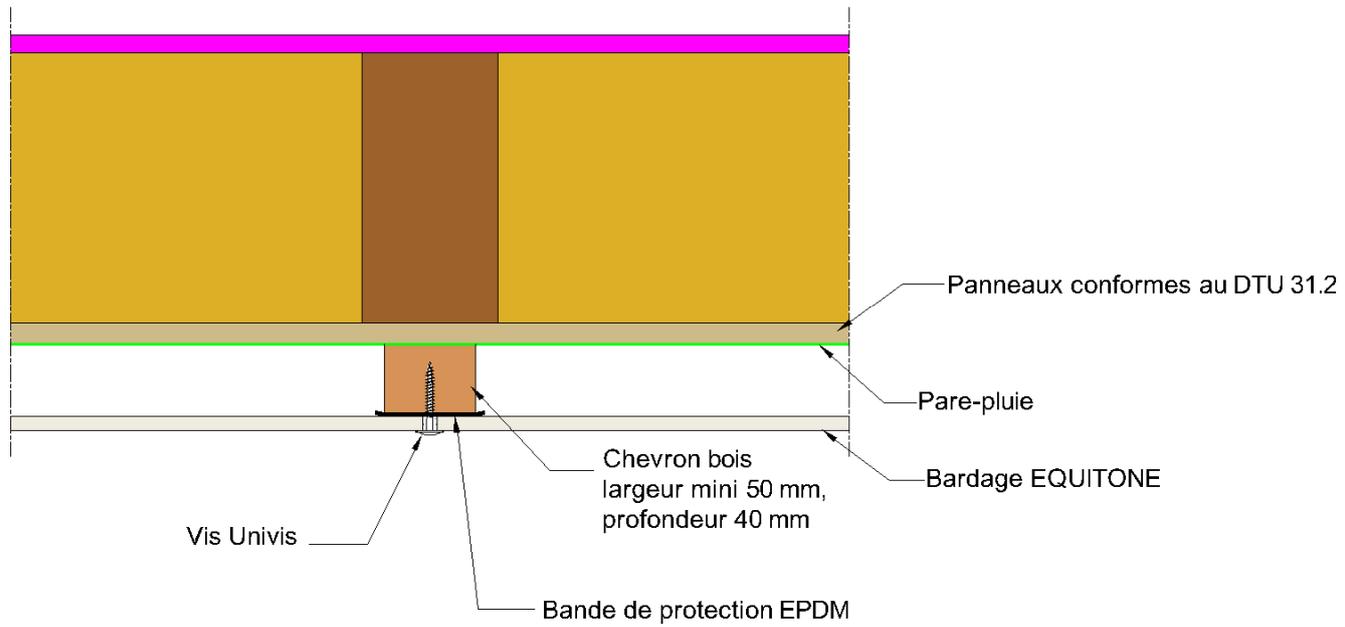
Rive haute et rive basse - Pose sur COB
